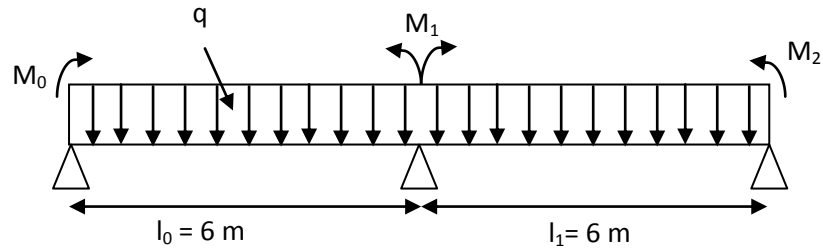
schéma statique de la poutrelle à l'ELU
